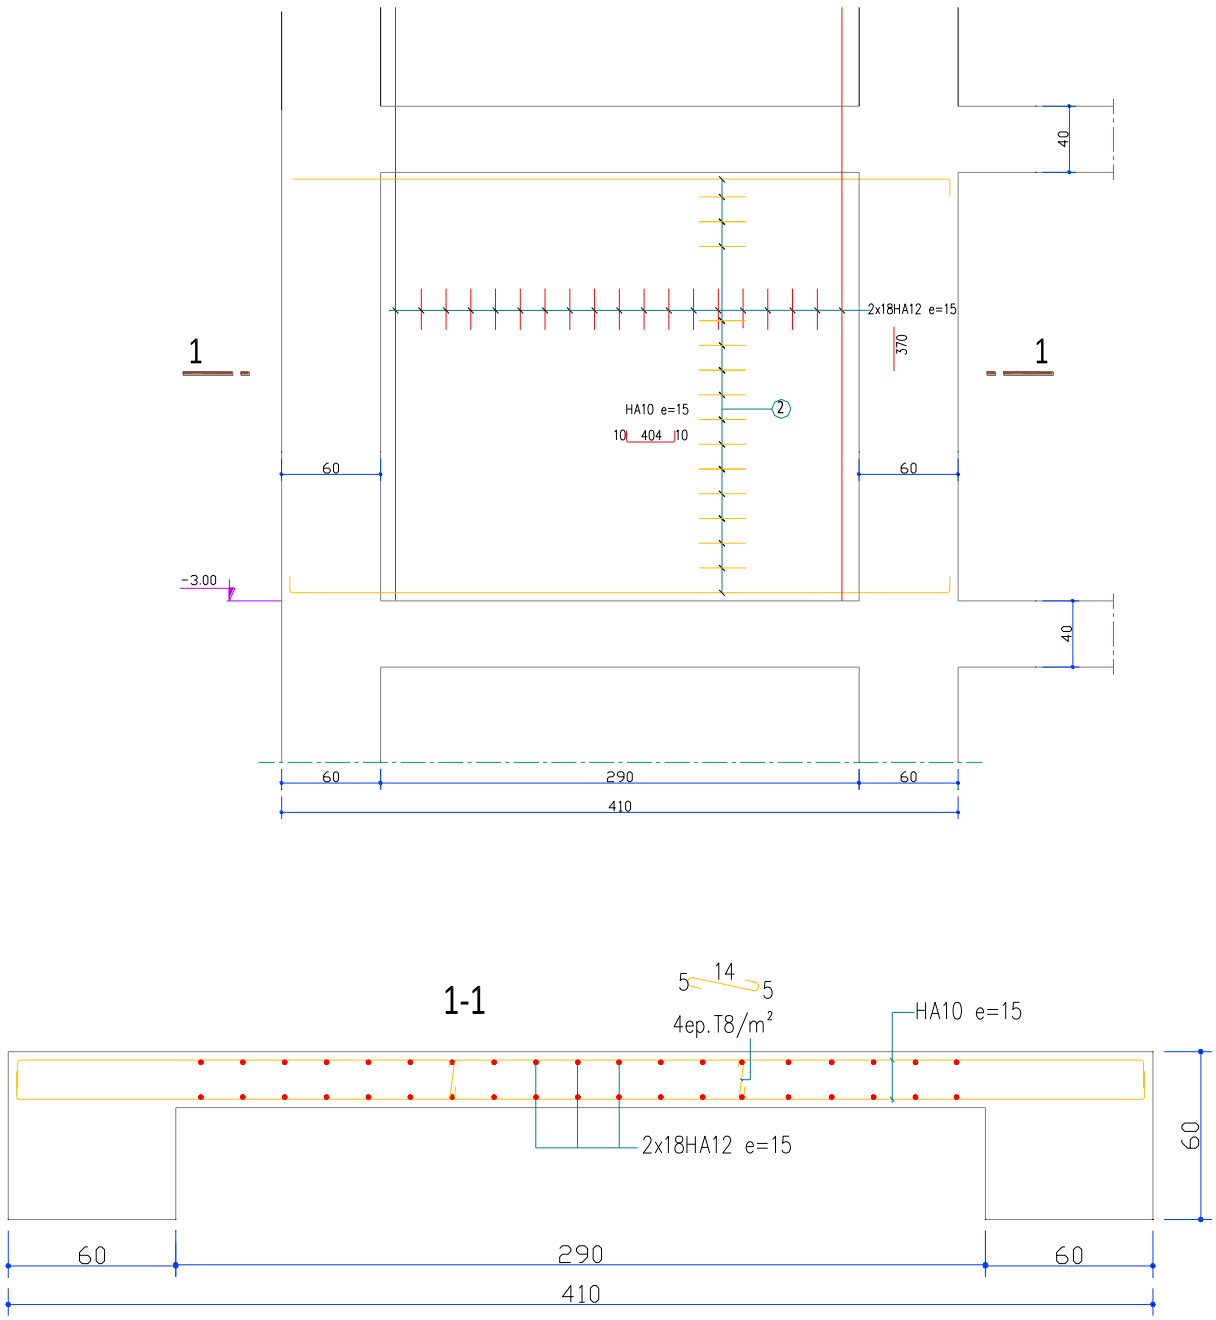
Exemple de ferrailage d'un type des voile périphériques.
